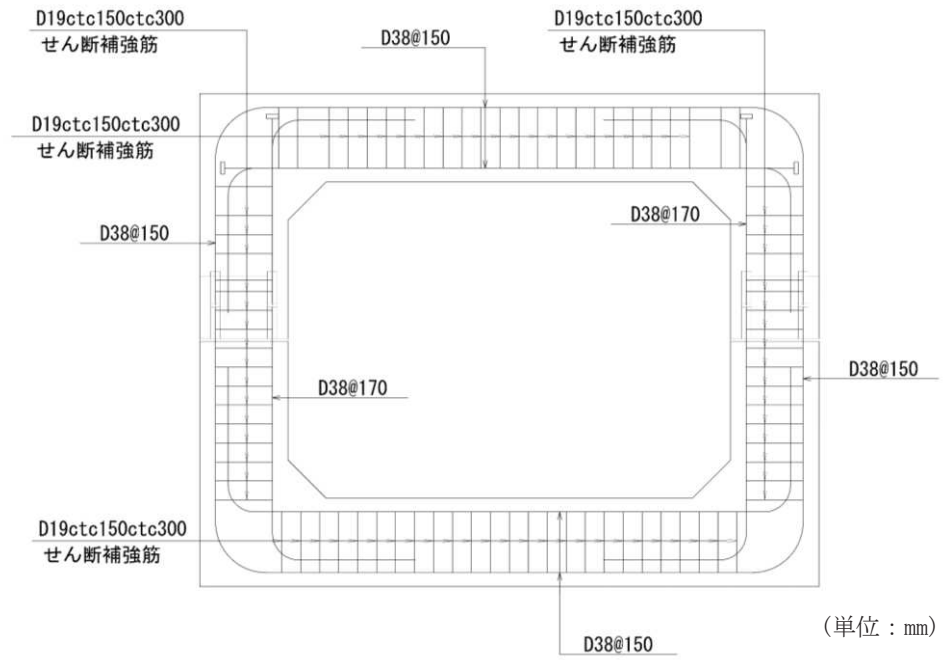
北側排水路の概略配筋図 (A-A 断面, B-B 断面共通)
